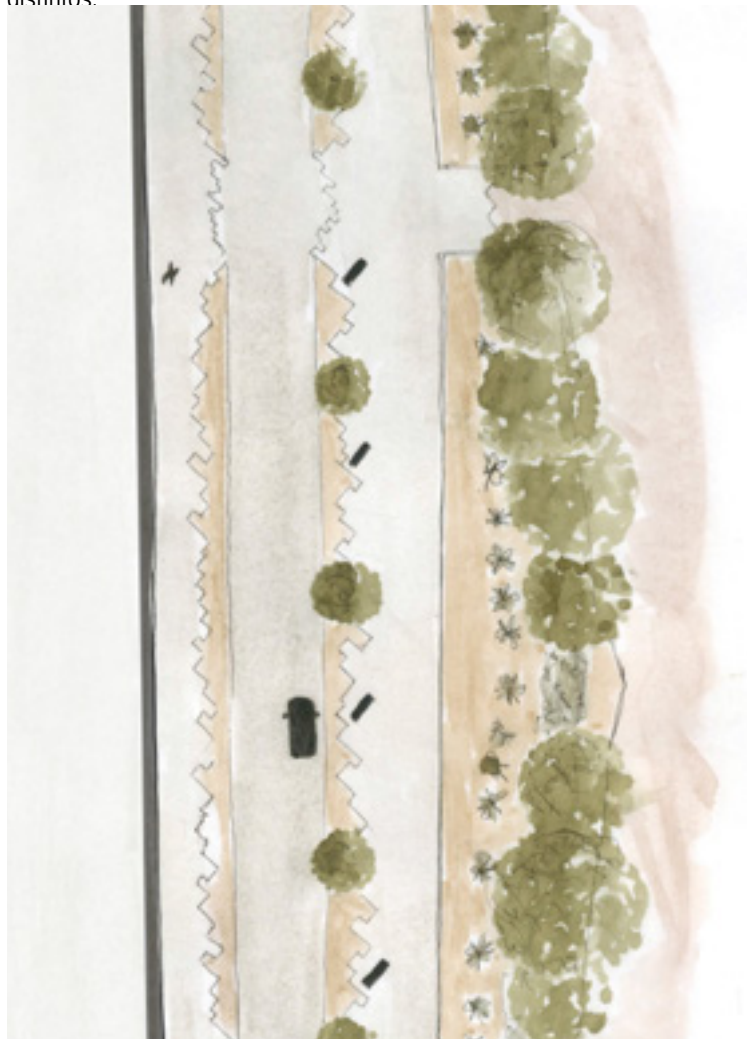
Planta ilustrativa da proposta da rua Zea Afonso
